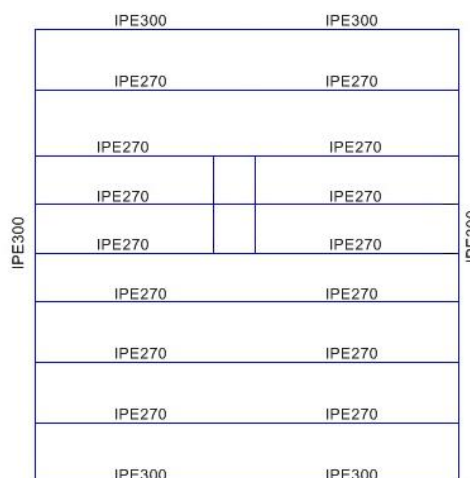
Identificação das Vigas do Piso Tipo.
